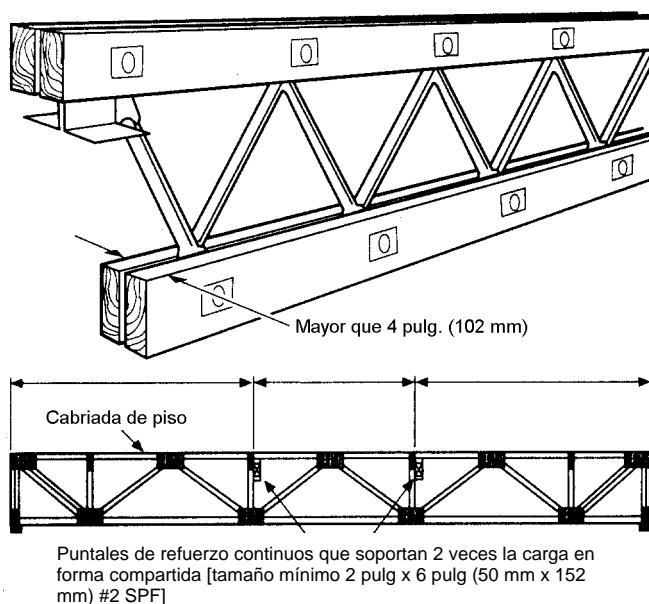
(b)(v) Ejemplos de construcciones con vigas de celosía de madera.
